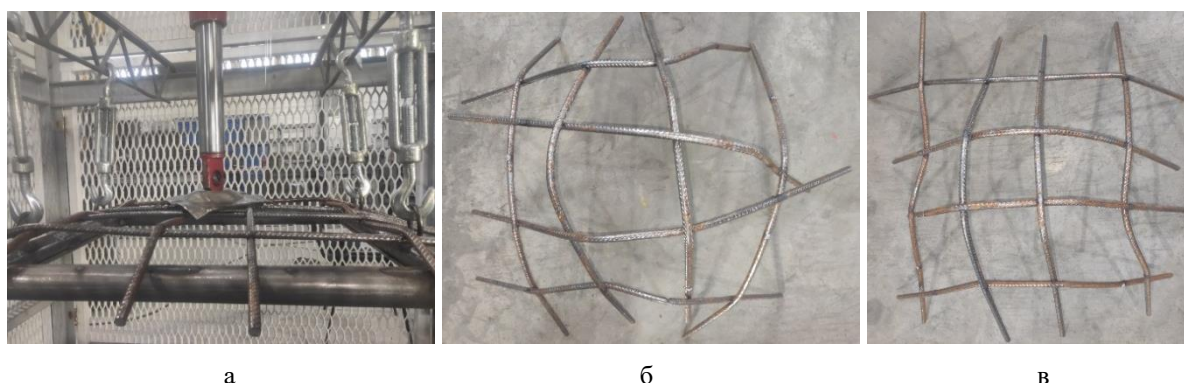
Испытание армокаркасов: а – общий вид стенда; б – вид армокаркаса без сварки в точках пересечения в центральной зоне; в – вид армокаркаса со сваркой во всех точках пересечения
